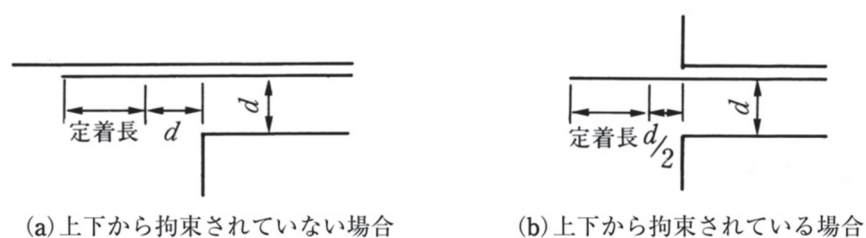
部材端部を他の部材に固定するときの鉄筋の定着の例
